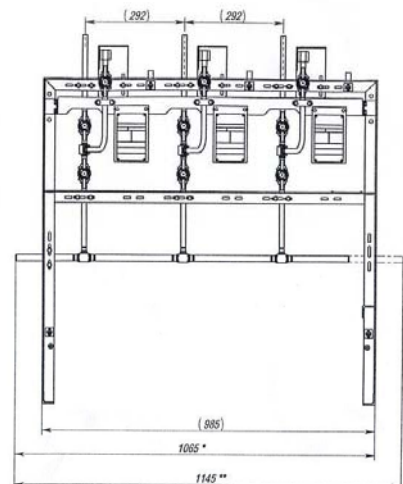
Панель для установки приборов штуцерной конструкции трёхместная
